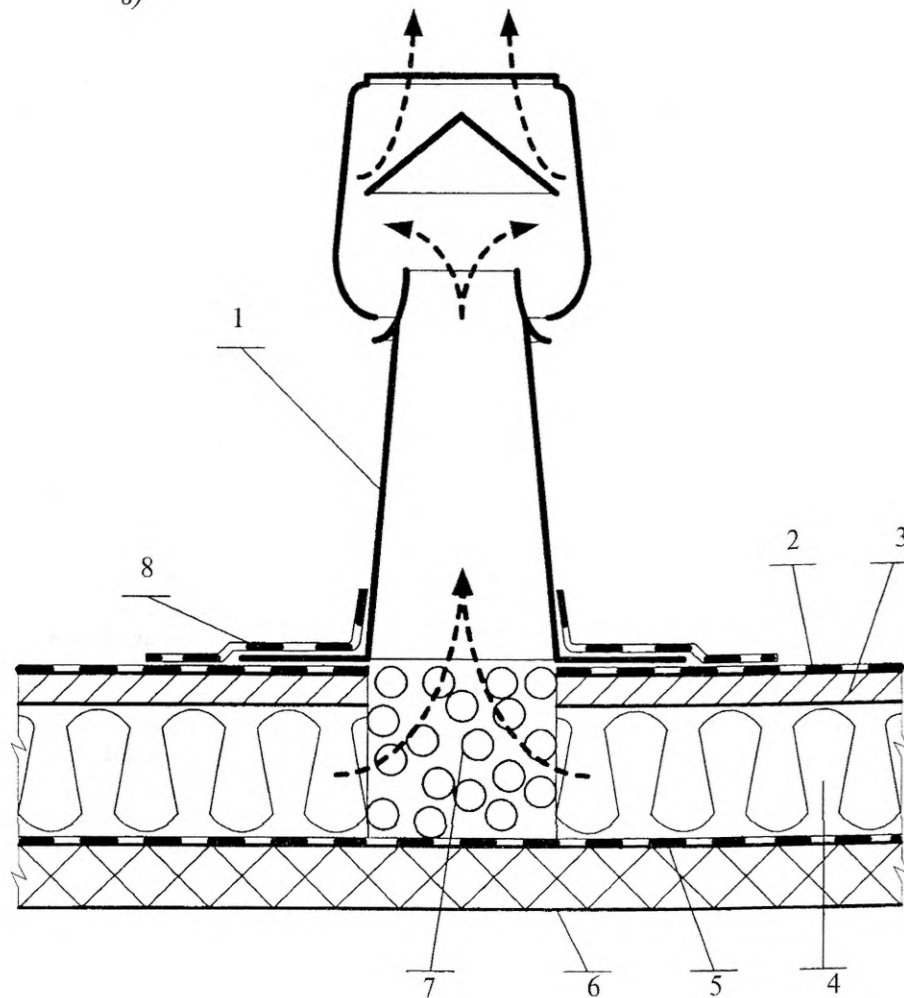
Примыкание водоизоляционного ковра к трубе:
